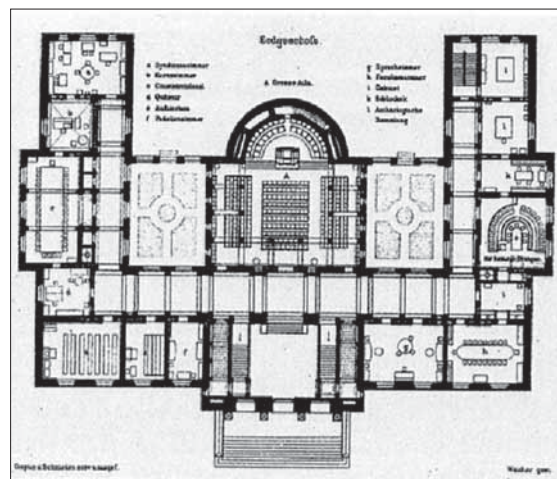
Grundriss des Hauptgebäudes der Universität zu Kiel
